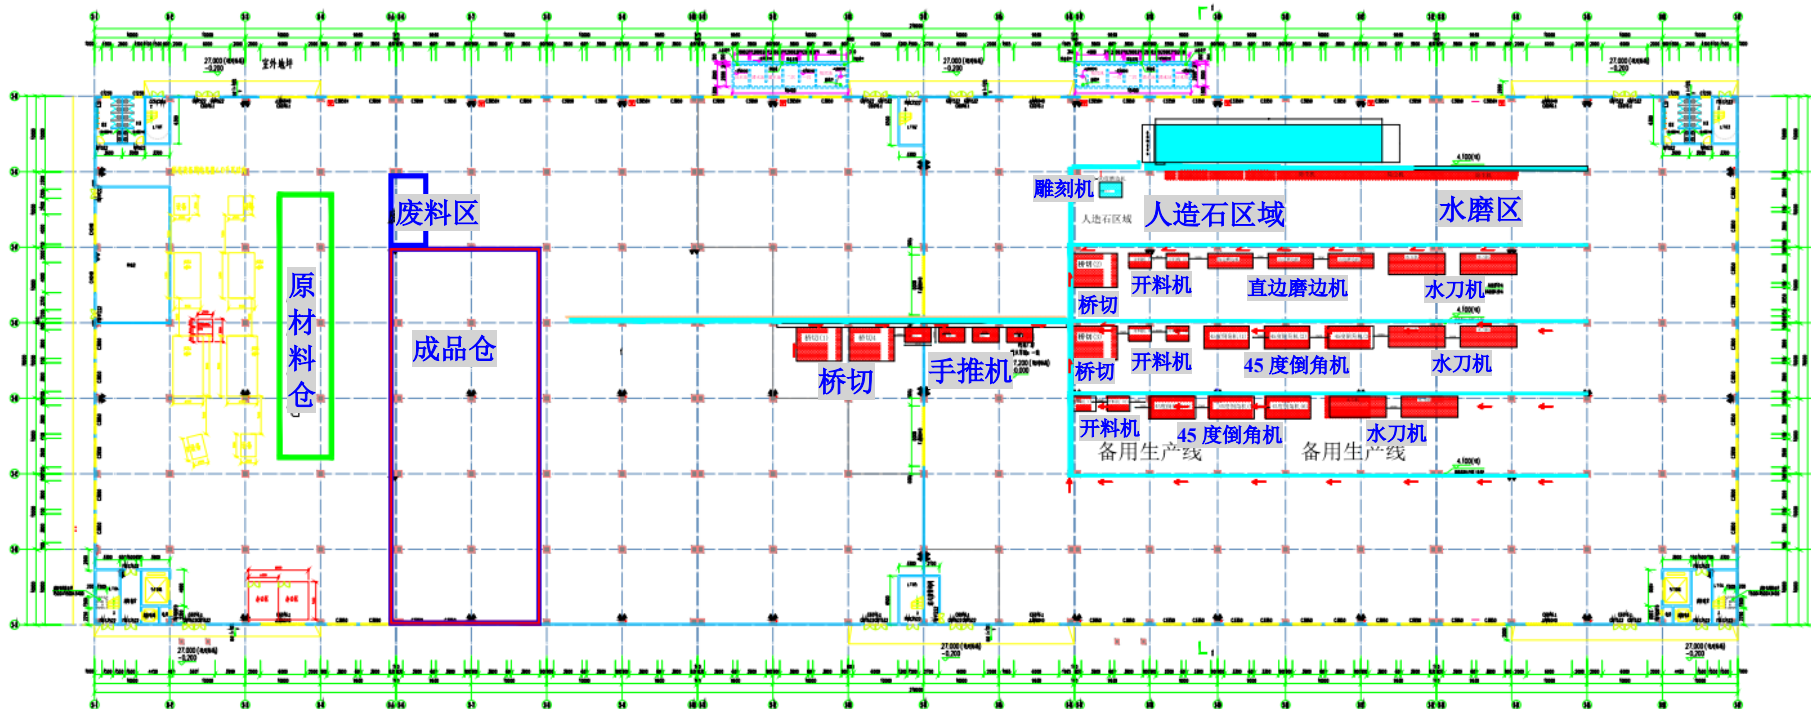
纸箱加工、石材台面加工车间（3#一层）平面布置图
